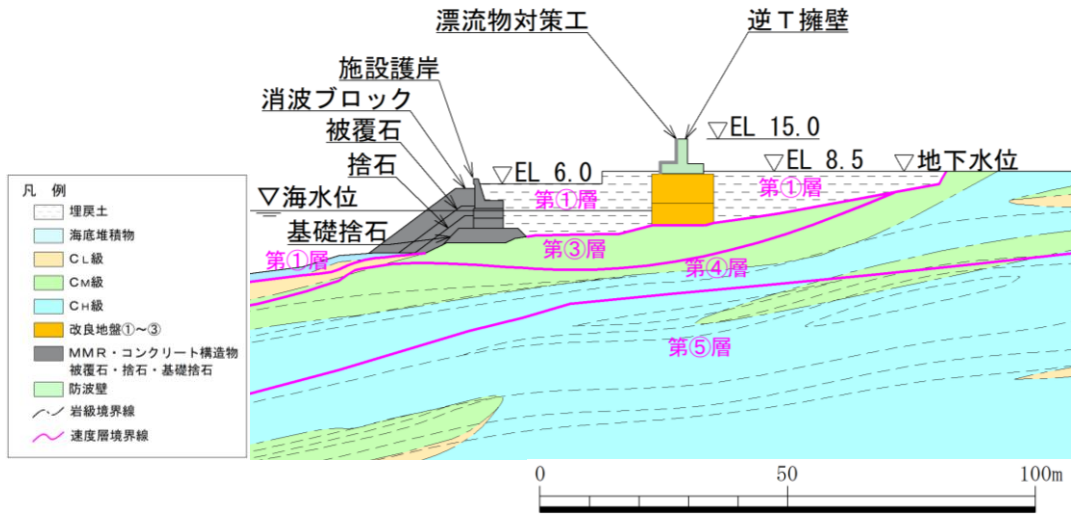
防波壁（逆T擁壁）の横断面図（①-①断面）
